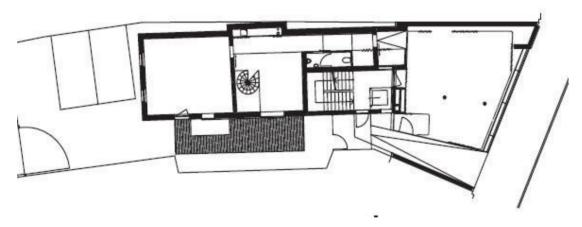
Planta Arquitectónica del primer nivel con uso de Oficina.
